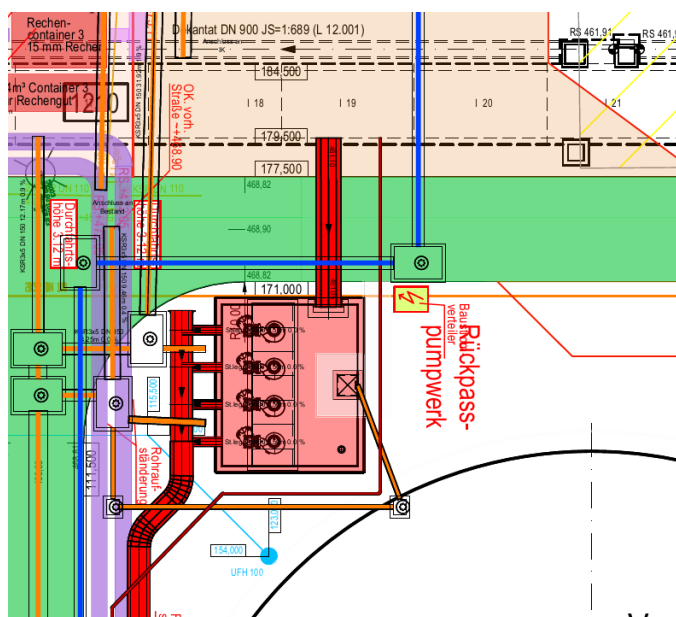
Planausschnitt geplantes Rückpasspumpwerk
